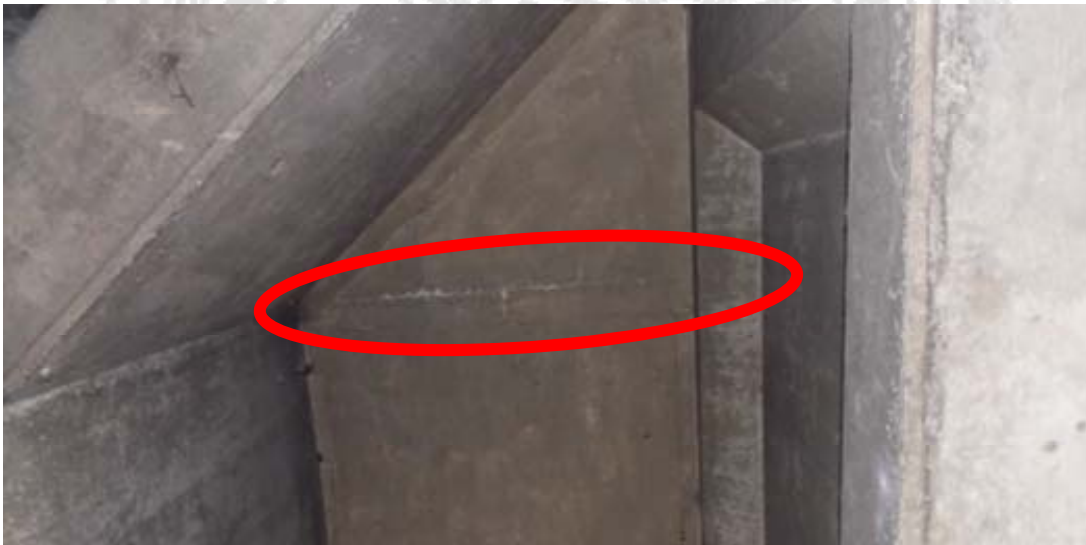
Se observaron algunas grietas transversales en la superficie inferior de la losa de concreto reforzado con evidencia de eflorescencia.
